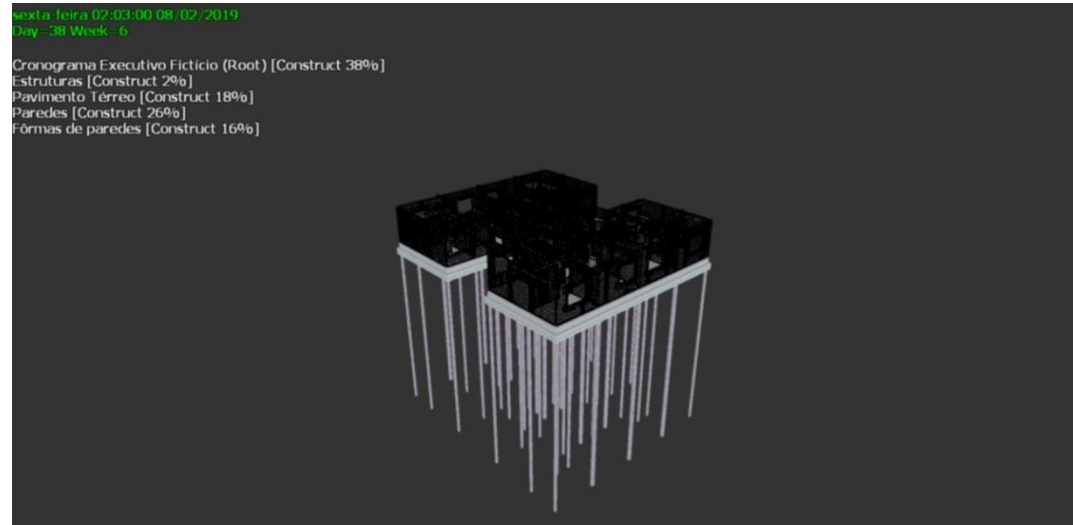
Paredes do pavimento térreo completamente armadas.
